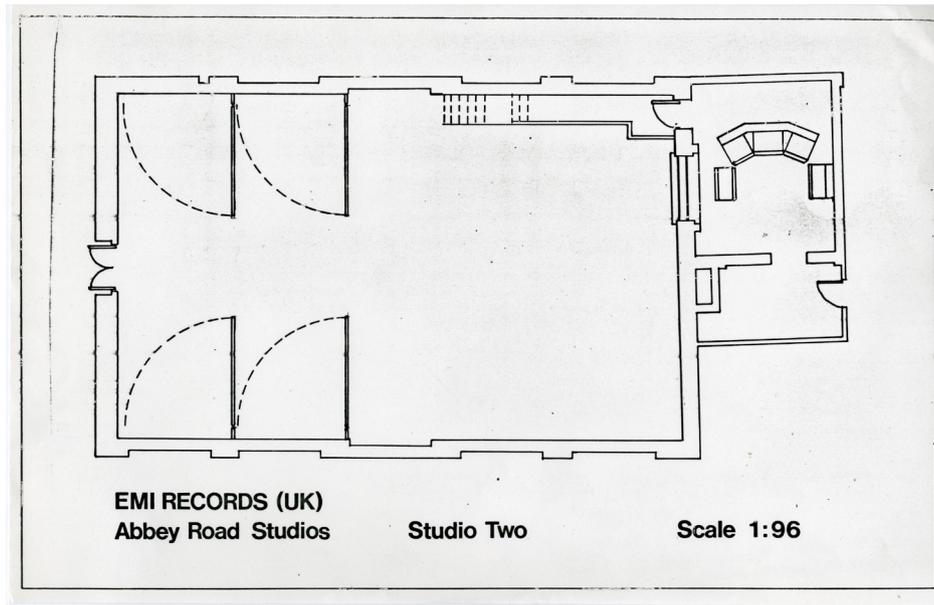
Planta Studio Two. Abbey Road (EMI). 1929
